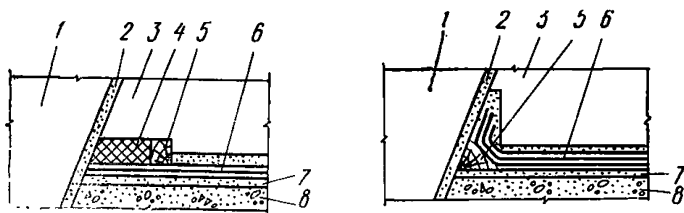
Примеры решений сопряжения оклеечной гидроизоляции дна (3) и штукатурной цементной гидроизоляции стен (1)
